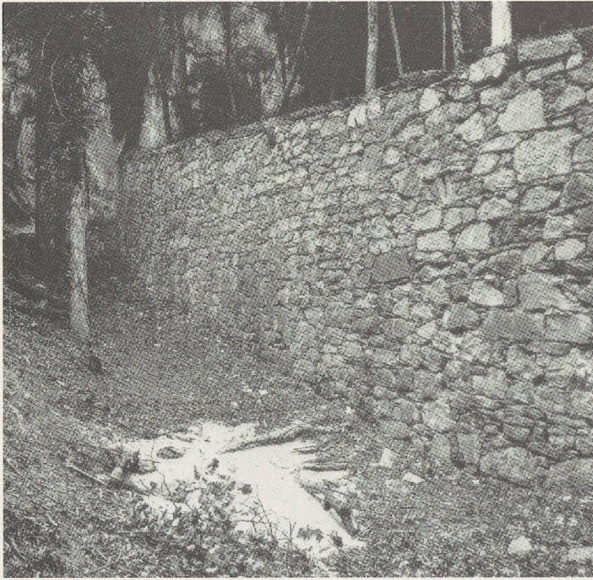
Le mur d'escarpe en pierres sèches et le fossé avancé de la Petite Tenaille de 1859 (W 22), hauteur: 6 m.
